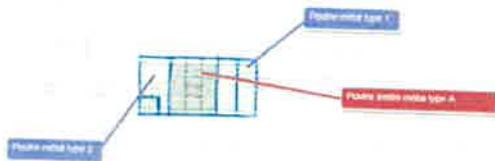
Entrée de la toiture-terrasse - Localisation des poutres métalliques de la zone locaux commissions
